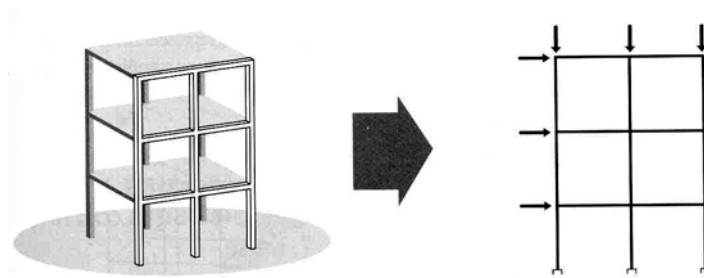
Modelo de pórtico plano (KIMURA, 2007).
